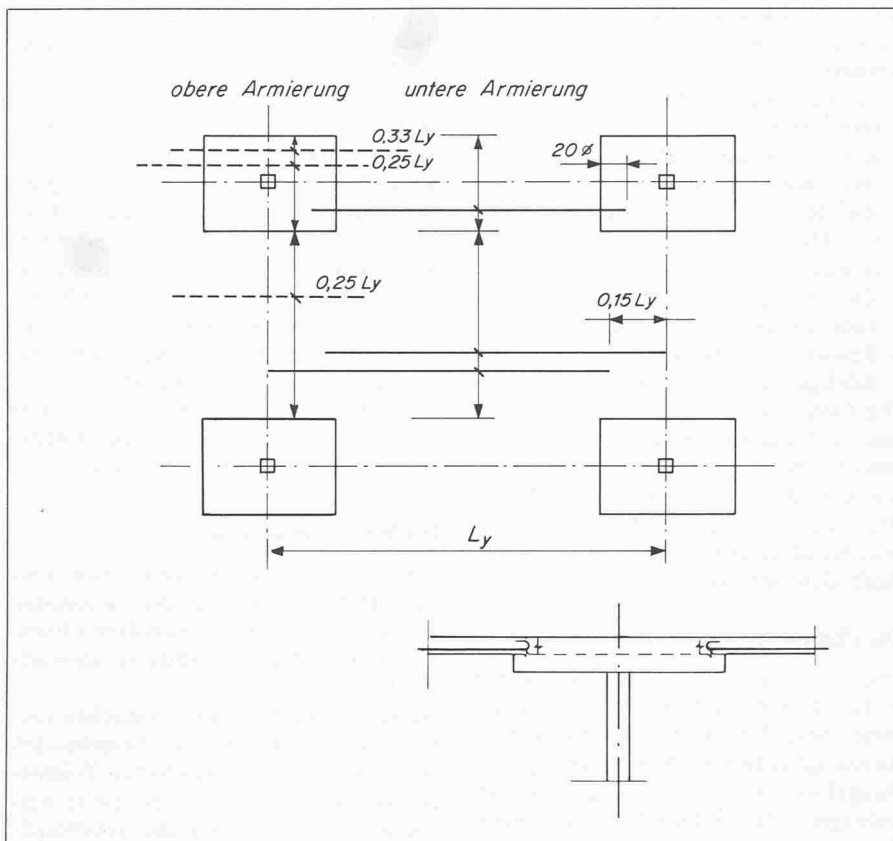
Armierungsschema. Grundriss (oben): Stablängen ab Systemachsen bzw. wie angegeben. (unten): Variante mit Arbeitsfuge beim Pilzrand
